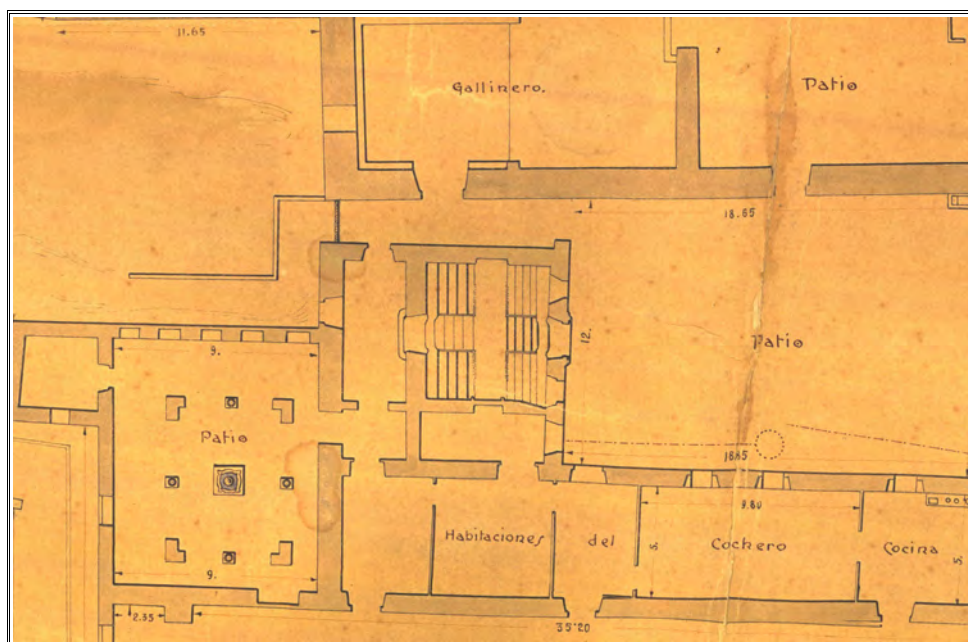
Detalle de la planta de las estructuras demolidas, al noroeste del conjunto palaciego, en el plano de 1920 de Félix Caballero.
